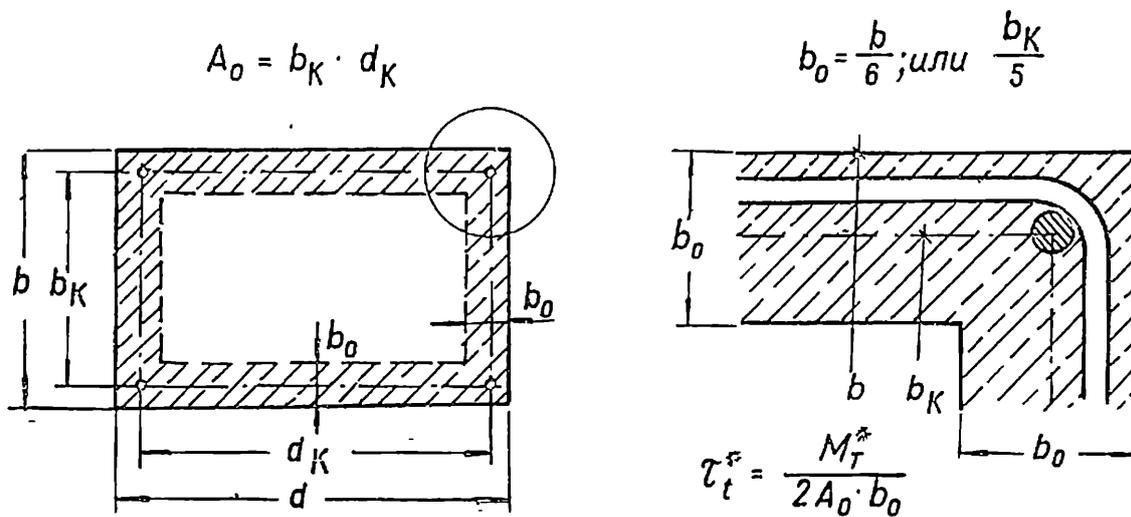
2. Коробчатое сечение, заменяющее сплошное прямоугольное сечение элемента
